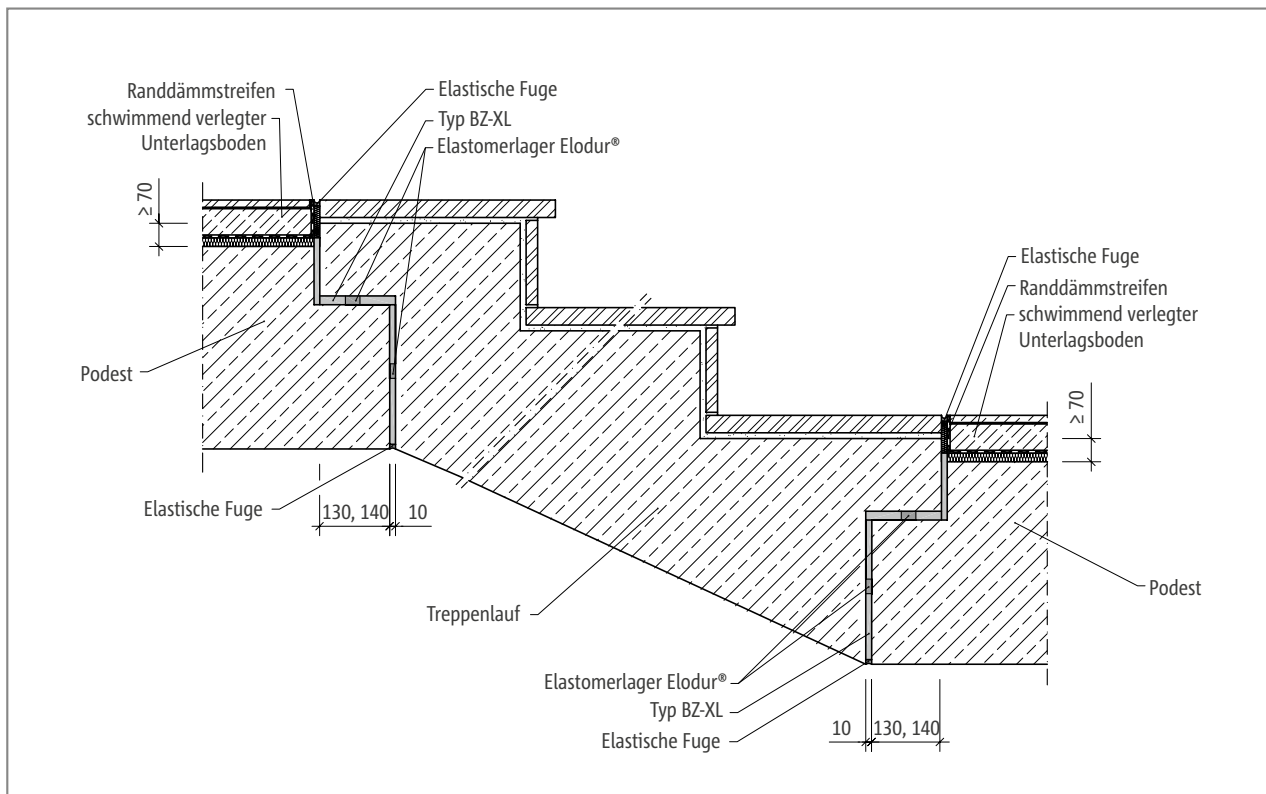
Schöck Tronsole® Typ BZ-XL: Einbauschnitt
